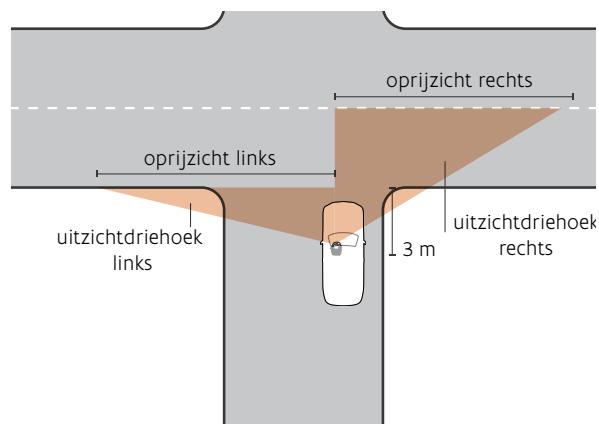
Oprijzicht en uitzichtdriehoek vanaf een ondergeschikte zijweg
